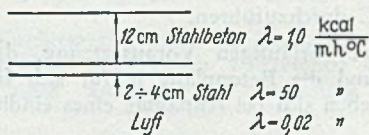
Schnitt durch Stahlbetonplatte mit Stahlblech.
